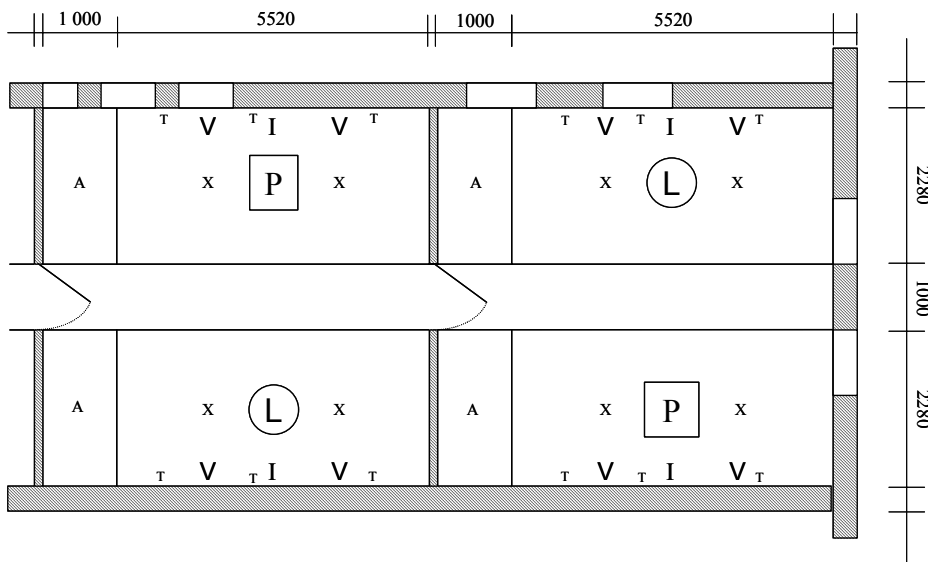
Grundriss der Versuchsabteile, Maßangaben in mm
